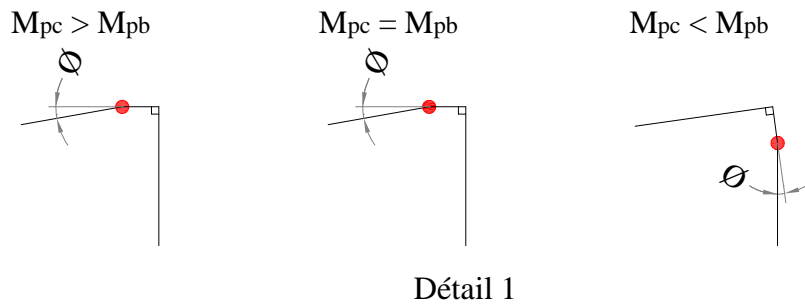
Détail 1 (Rotule plastique dans les jonctions poteaux-poutres)
